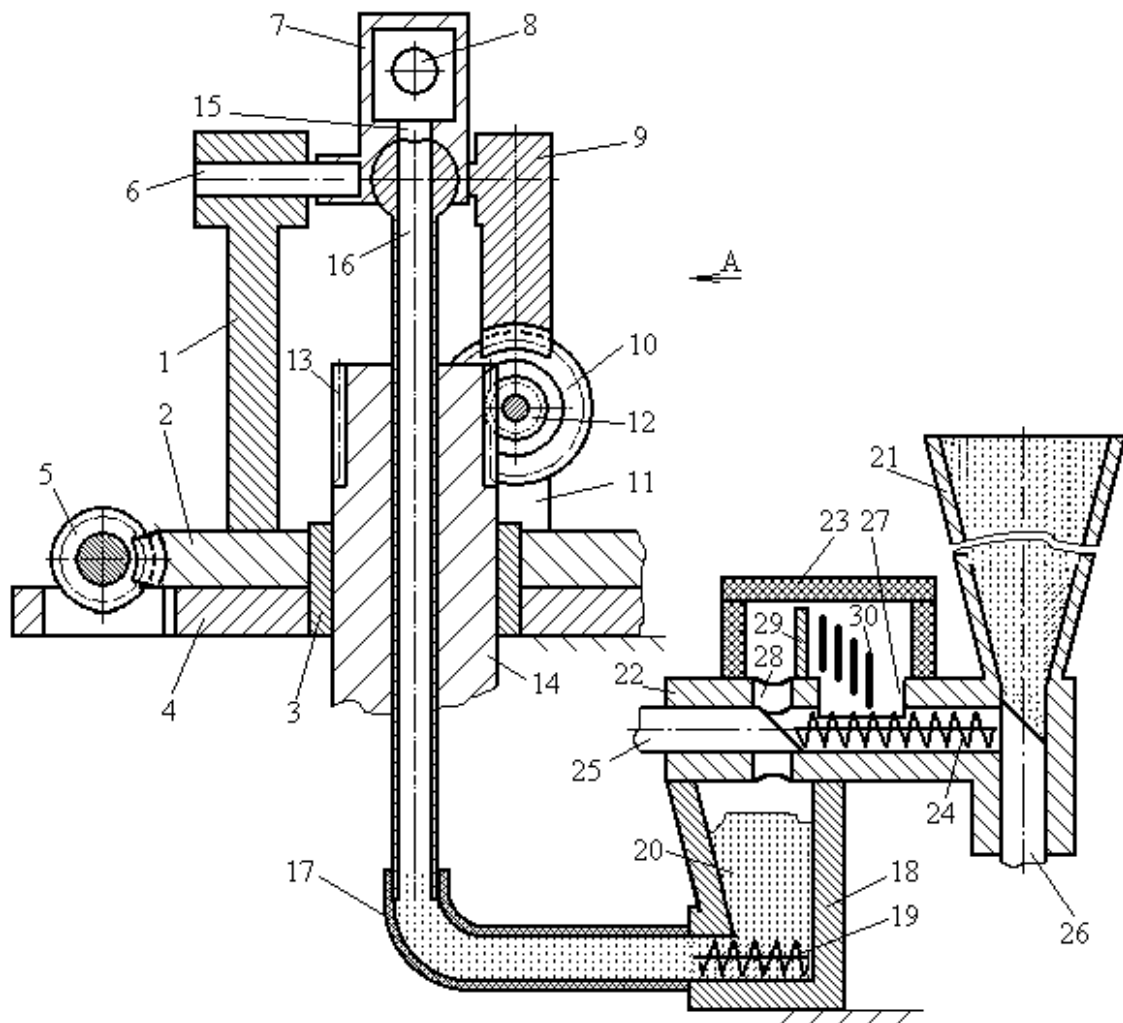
Схема устройства для автоматической обработки дорожного покрытия противогололедным веществом
